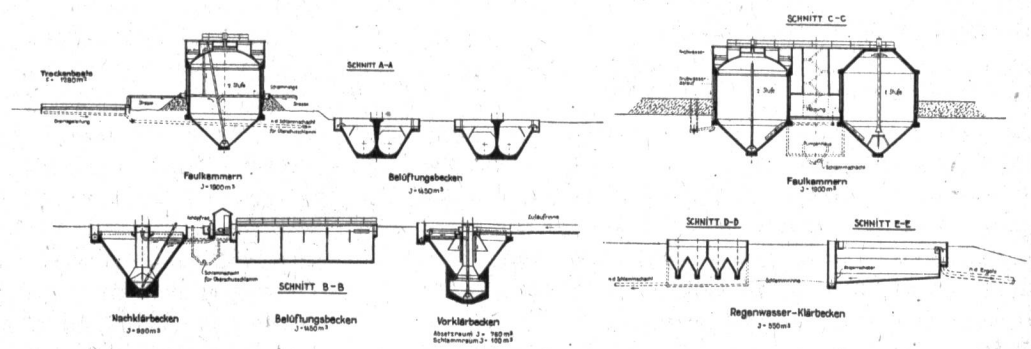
Abwasserreinigungsanlage Niederschönthal. Schnitte zum Grundriss Abb. 2.
